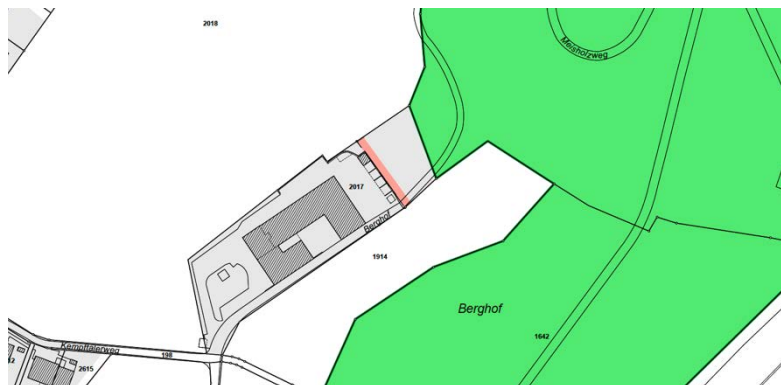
Auszug Ergänzungsplan Waldabstandslinien
